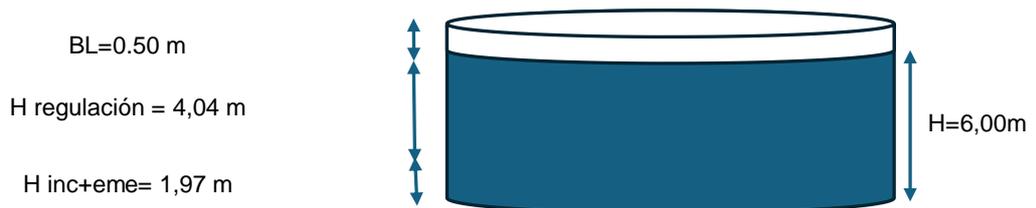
Dimensiones de Tanques Superficiales tipo 1 para Pozo 1 (Fuente: Autor)
